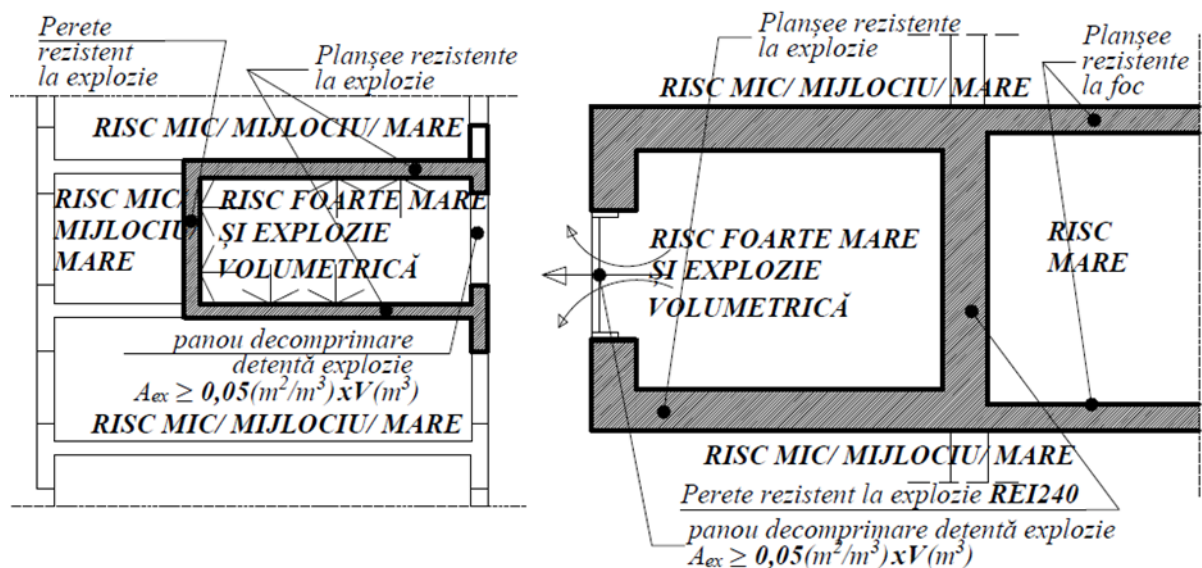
Разделение стойкими к взрыву конструкциями
